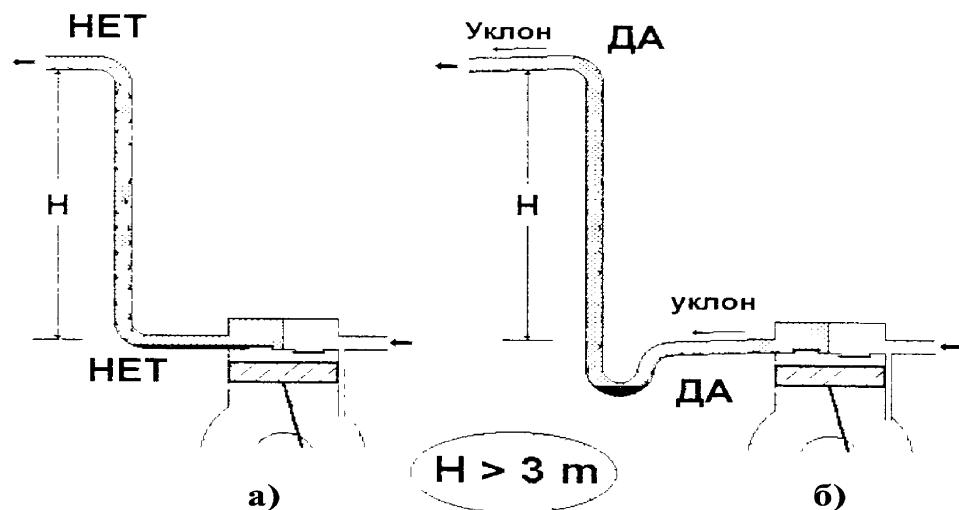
Установка маслоподъемной петли на выходе из компрессора:
